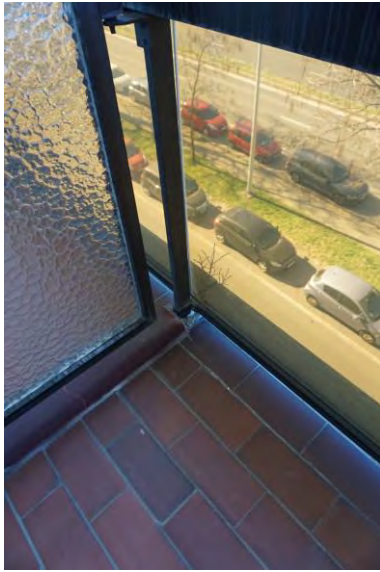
Vulpaneel schrijnwerk achter scheidingspaneel terrassen
